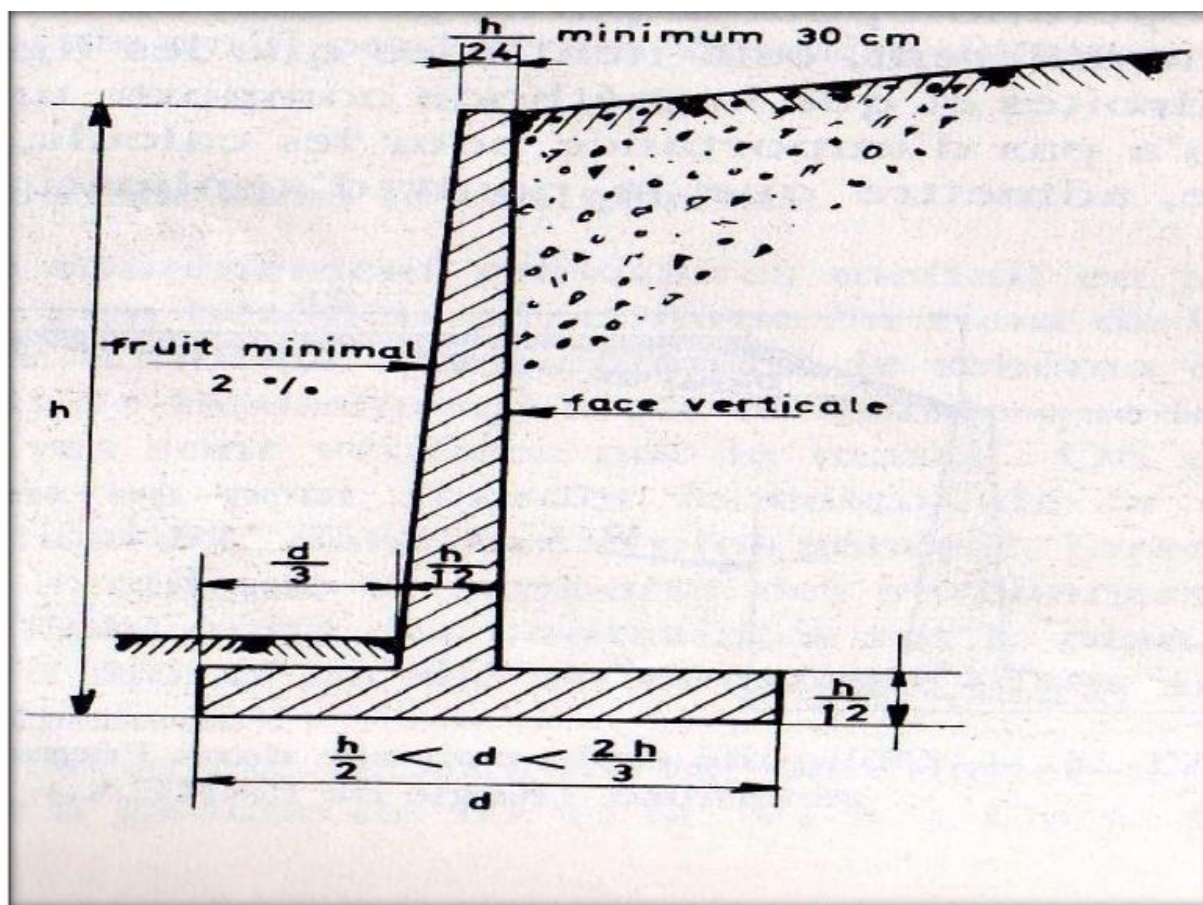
Dimensions usuelles d'un mur de soutènement en Béton armé.[1]
